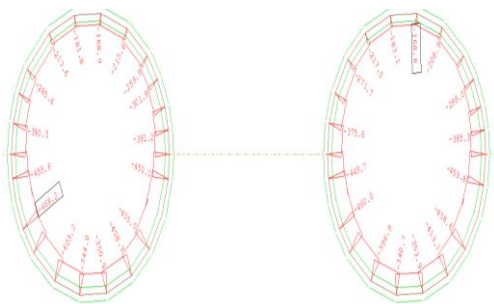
Эпюра продольных усилий, возникающая в конструкции железобетонной обделки
